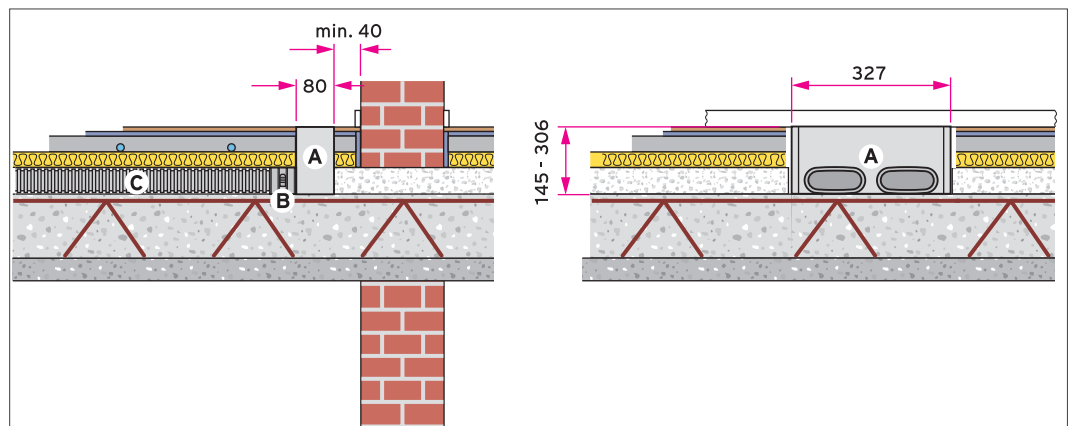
Rechteckiger Luftauslass, Bodenmontage - Verlegung im Fußbodenaufbau
